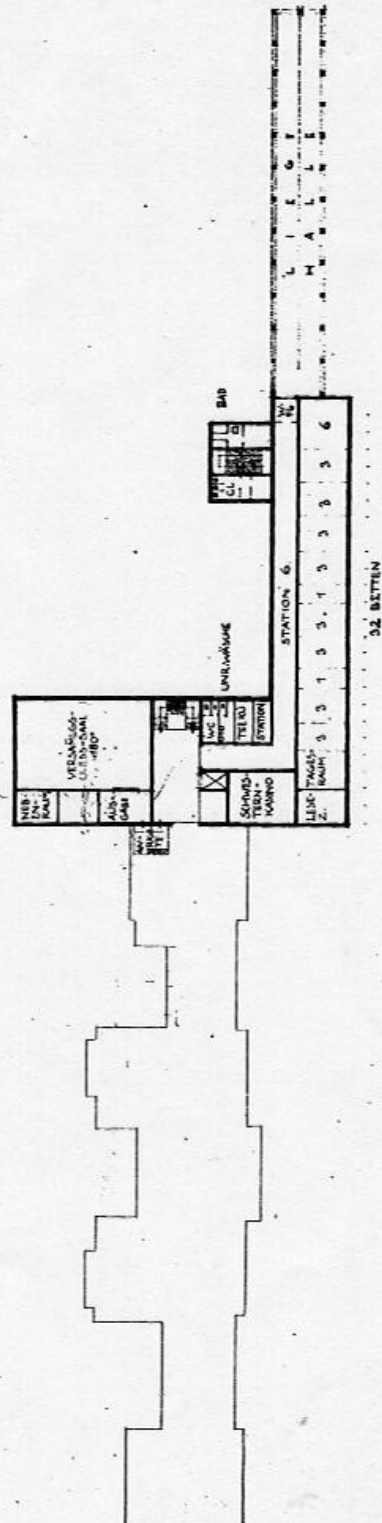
Erweiterungsplanung 1938 – Grundriss Erdgeschoss³⁸²
